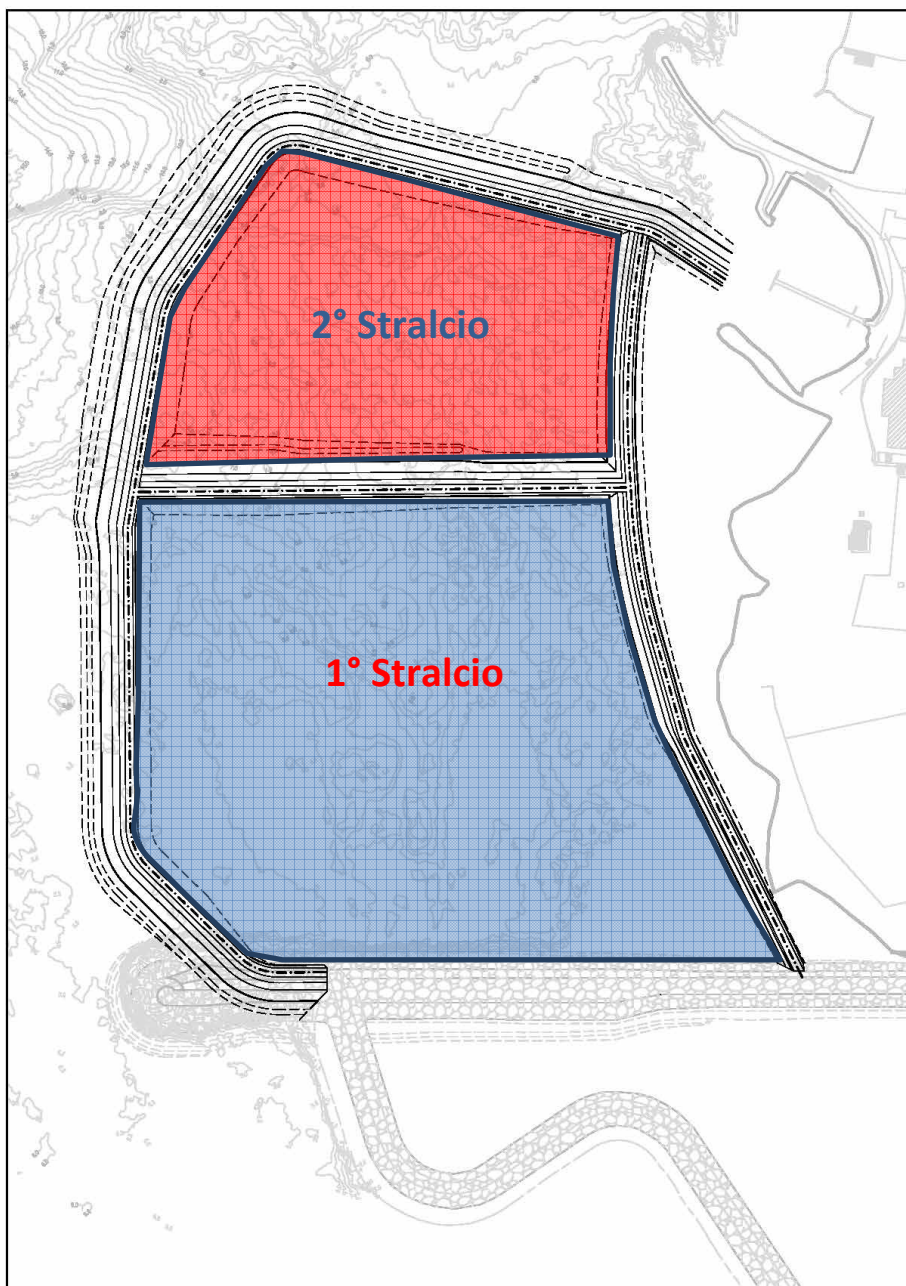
Planimetria individuazioni stralci funzionali (fasi)
